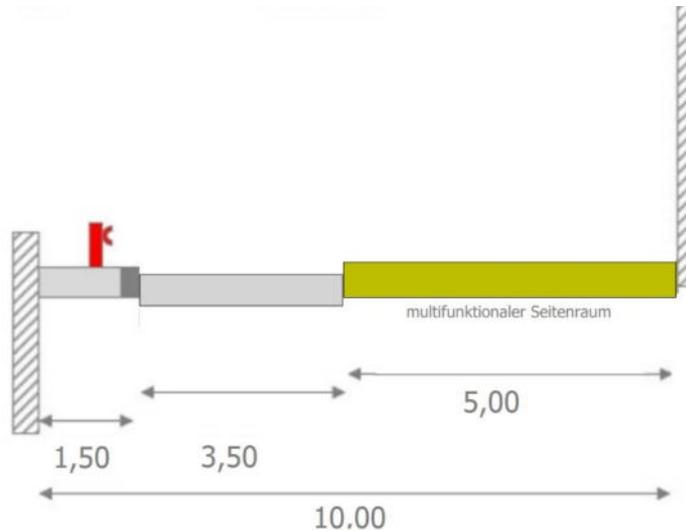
Regelquerschnitt der neuen Straßenverbindung [Darstellung: bsv Büro für Stadt und Verkehrsplanung]
